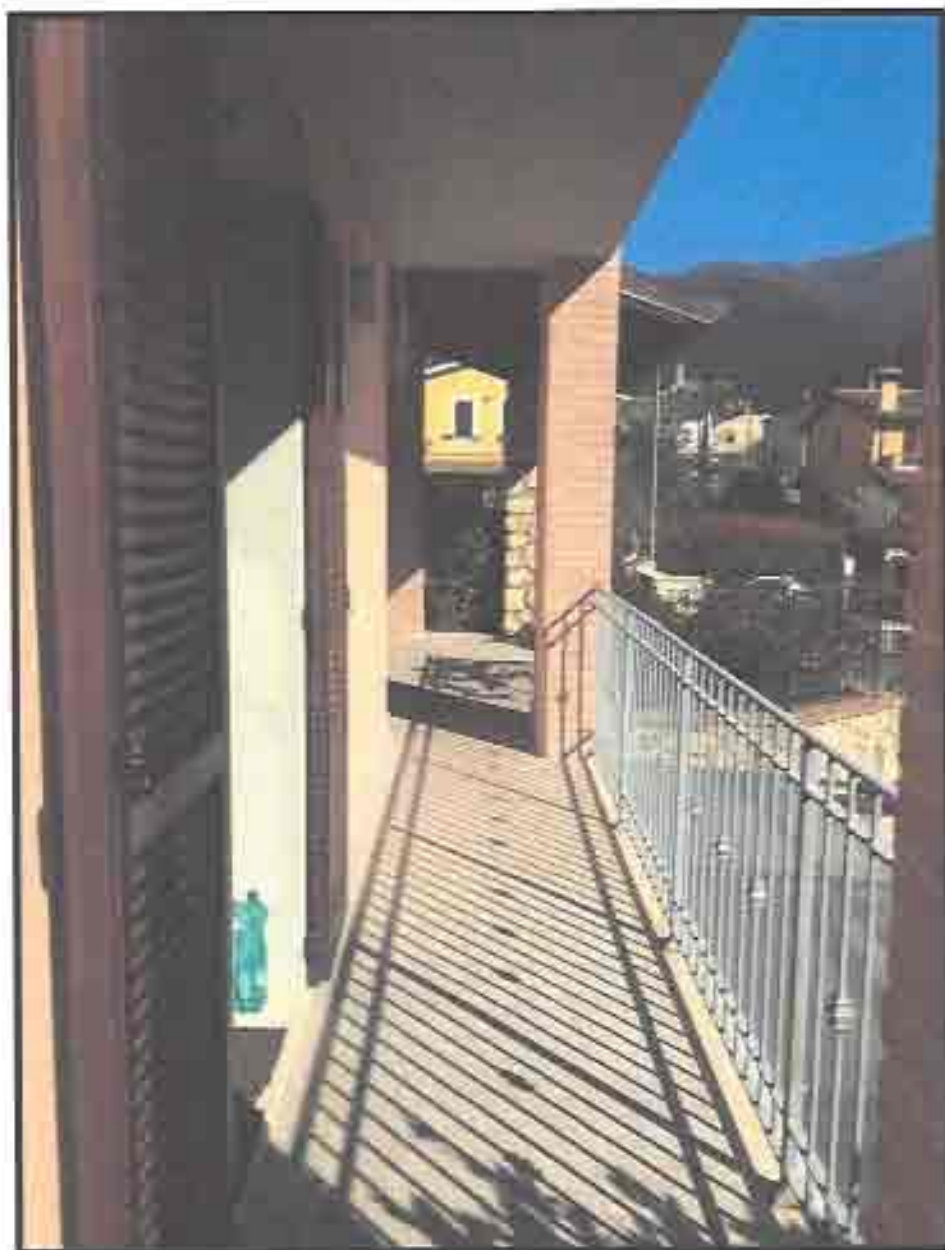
particolare balcone al piano primo dell'immobile in oggetto di perizia
